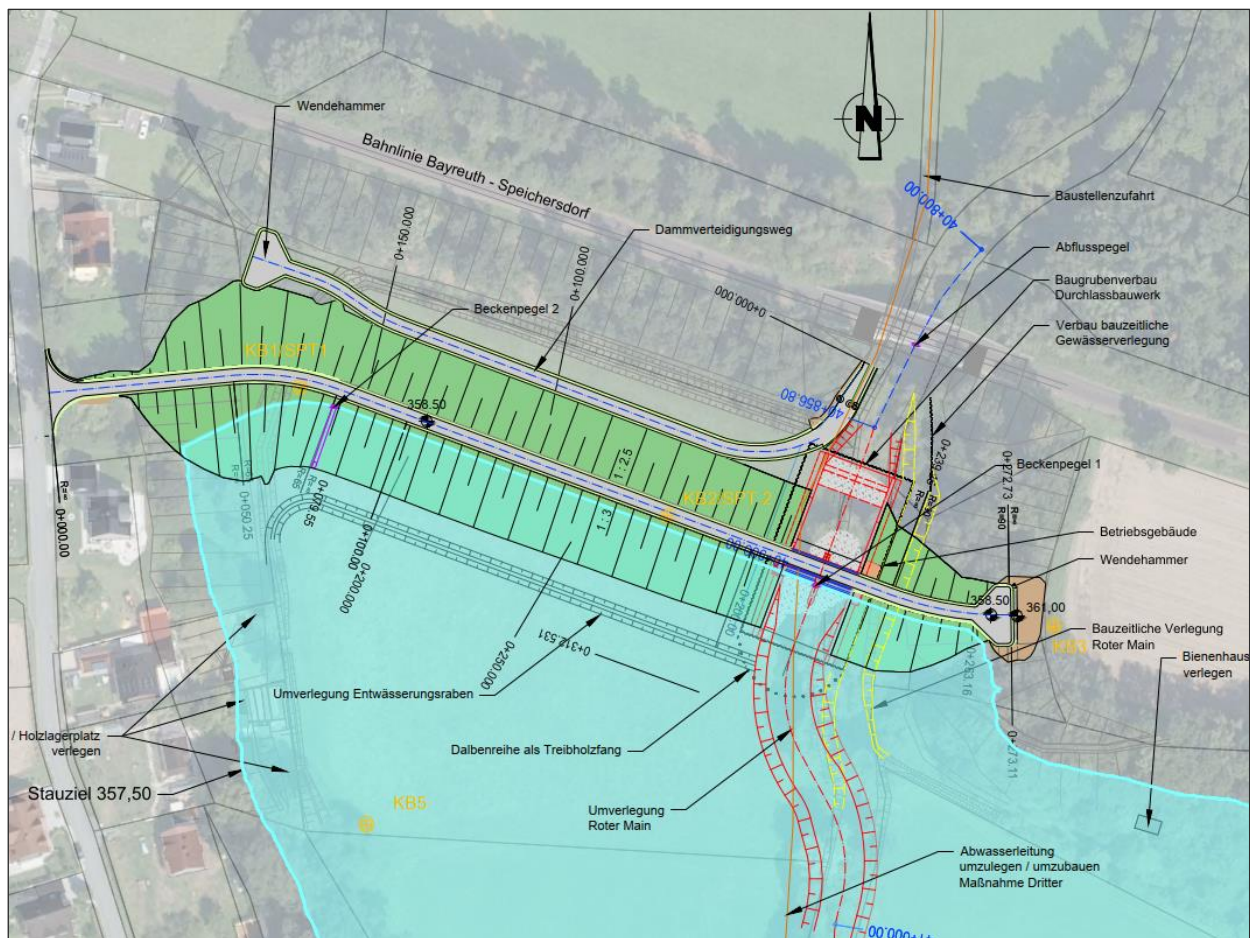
Draufsicht geplantes Dammbauwerk HRB Bauernhöfen, Quelle: THP
